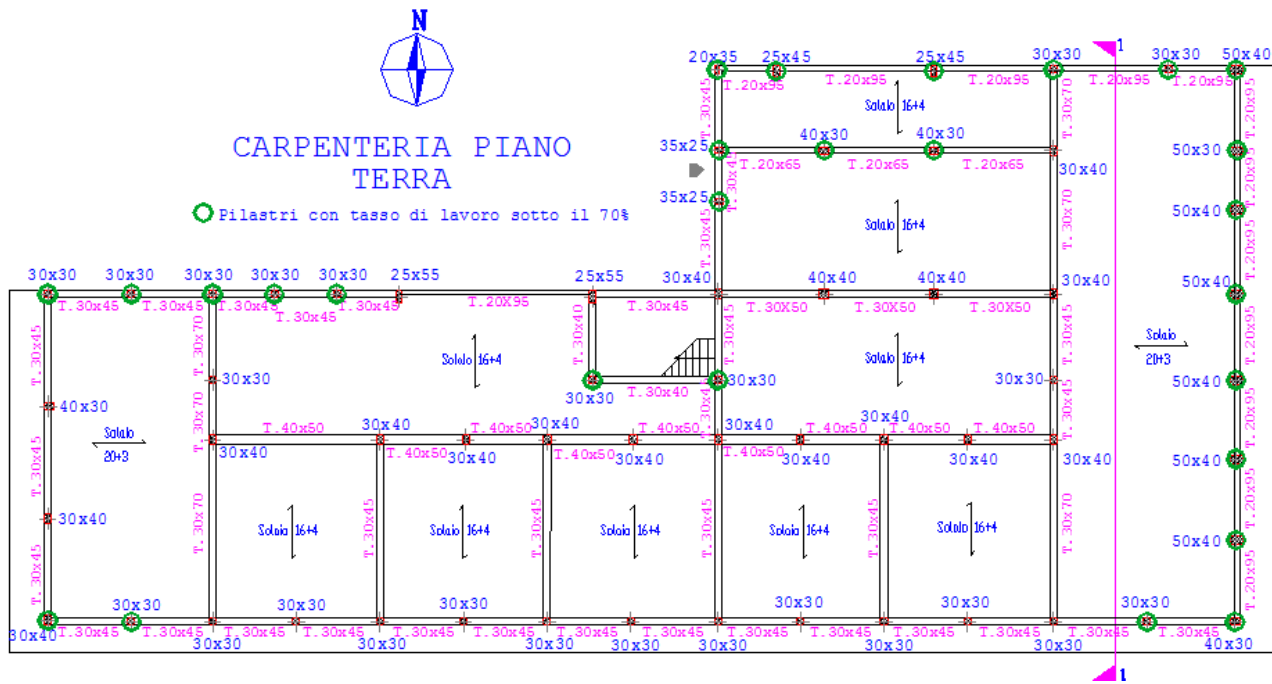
Pilastri al piano terra con tasso di lavoro inferiore al 70%
